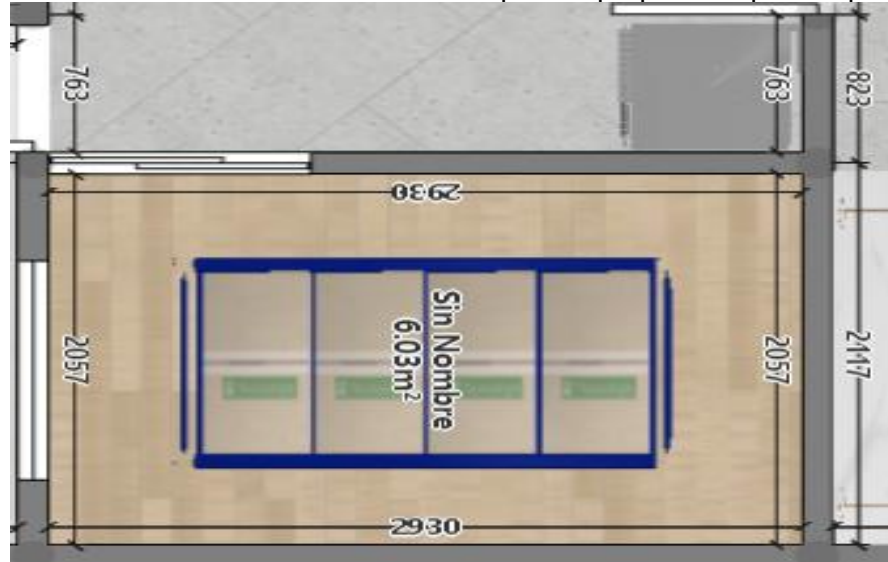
Plano actual en 3D de la planta “Aplanchados con Amor”, vista superior
